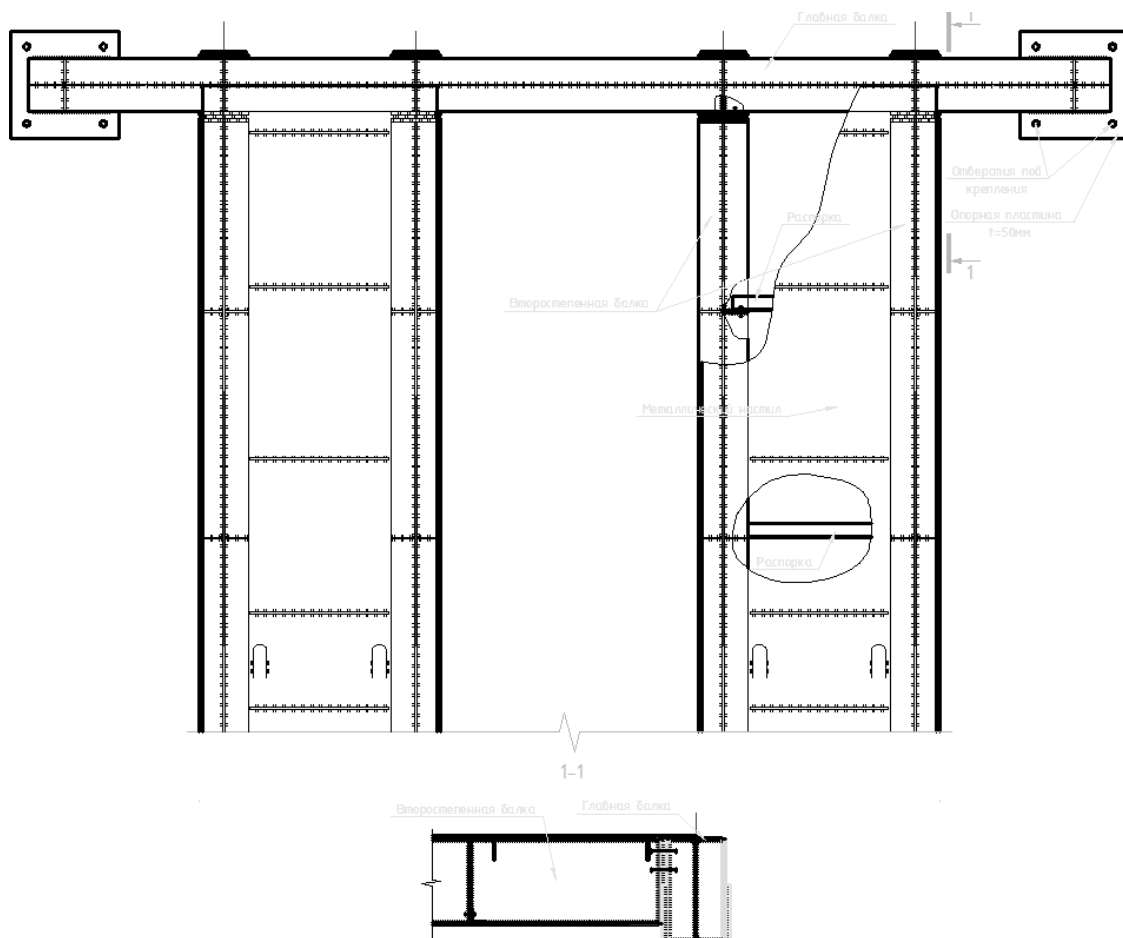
Металлическая опорная площадка для передвижения крана по перекрытию
